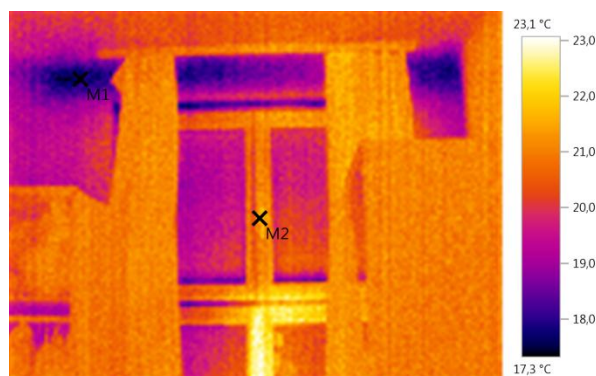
Innenaufnahme eines Unterkunftsfensters mit Stahlbetonüberlager
